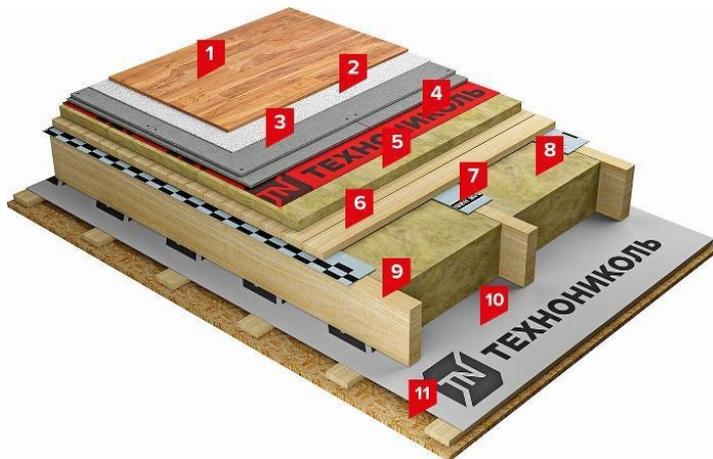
Конструктивное решение междуэтажных перекрытий по деревянным балкам:
